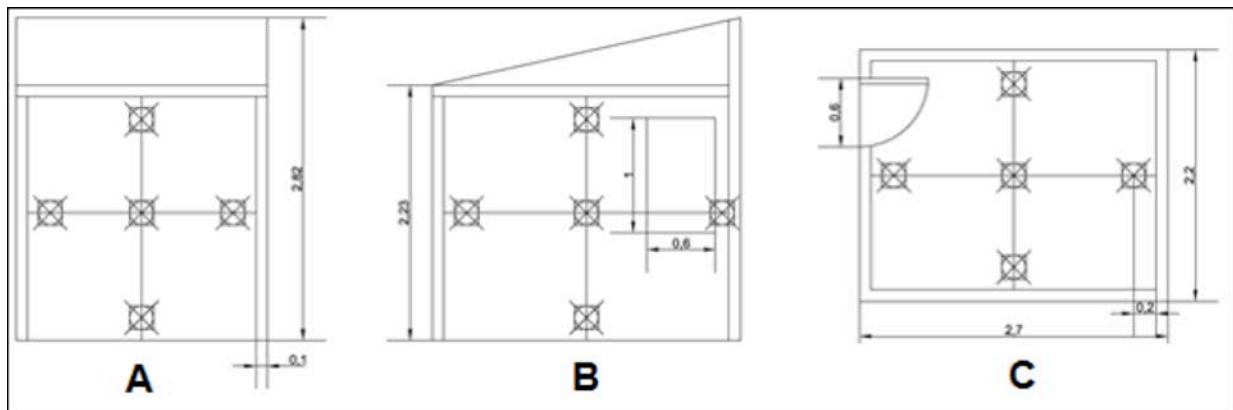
Distribución de las termocuplas tipo T (Copper-Constantan). A: En fachadas poniente. B: En fachadas norte. C: En techos. Fuente: Elaboración propia (fuera de escala)
